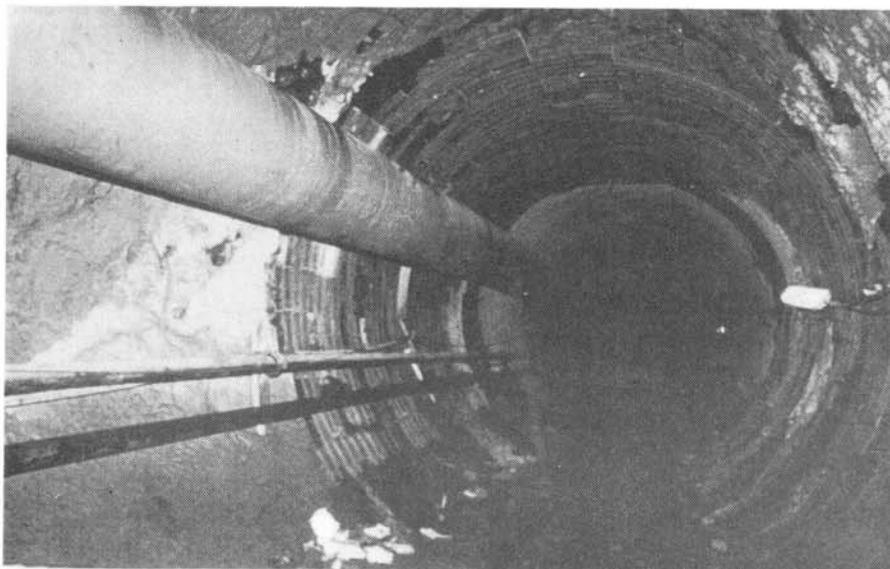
Galleria \varnothing 6.00: zona fratturata con blingaggio di contenimento
